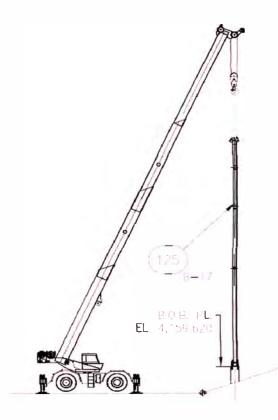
Posición de equipos para maniobra de montaje de la cepa B17
